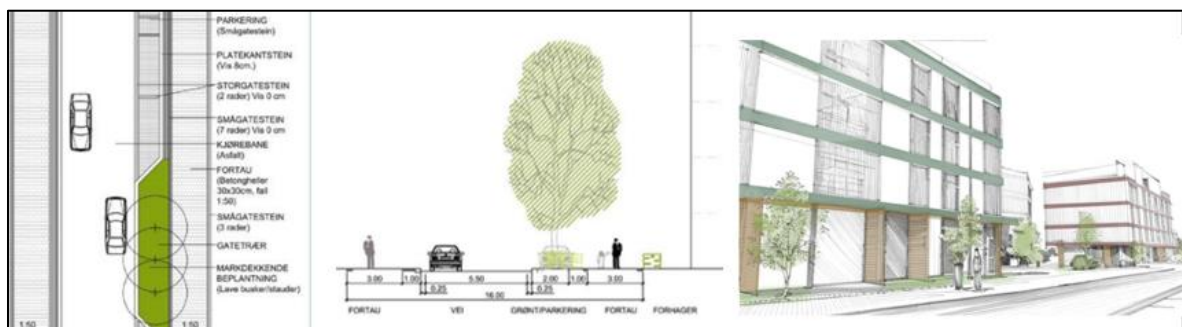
Prinsippillustrasjoner plan, gatetverrsnitt, gaterom.
